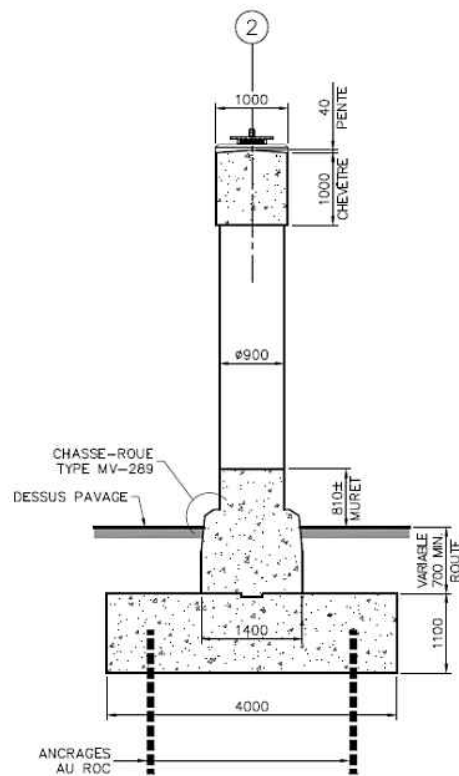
Pont d'étagement routier – Pile axe 2 – Coupe type colonnes rondes
